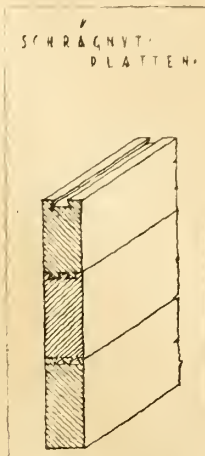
Schrägnutplatte der Holzwerke Höfler.
